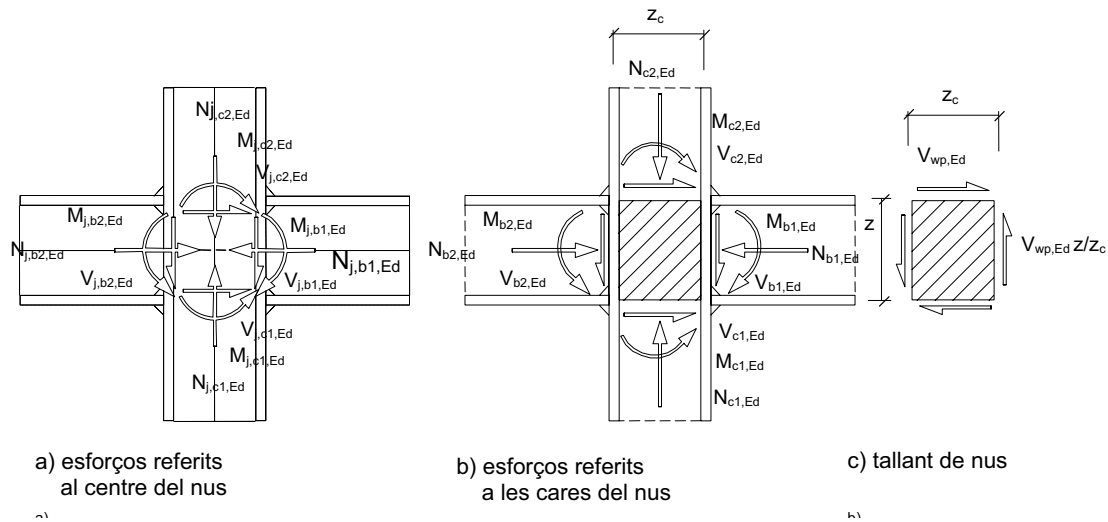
Unió (soldada o collada) i tallant de nus
